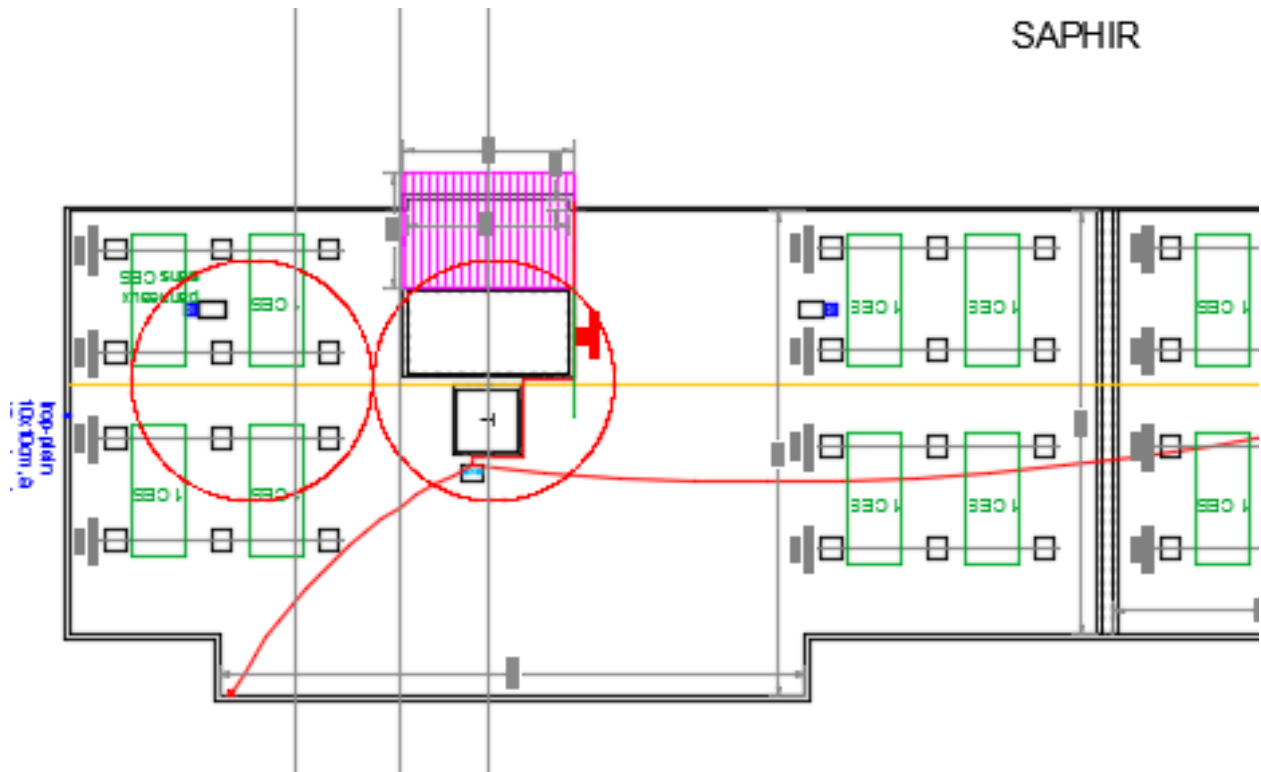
Extrait du plan de la toiture du bâtiment SAPHIR
